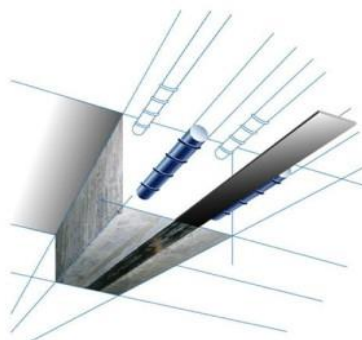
Banda de refuerzo actuando junto a las armaduras.
